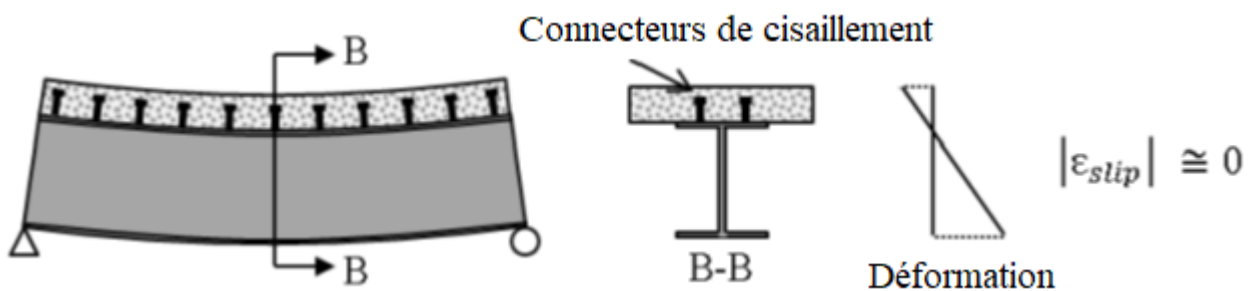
2 Comportement entièrement composite des poutres mixtes[1]
